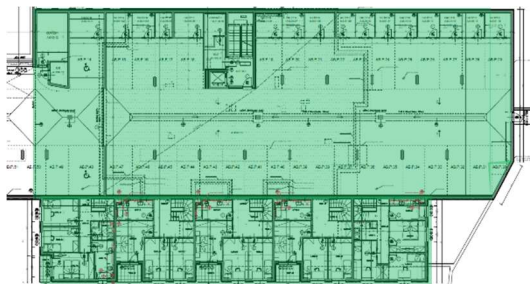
Půdorys a řez 2.PP; zdroj: [16]
